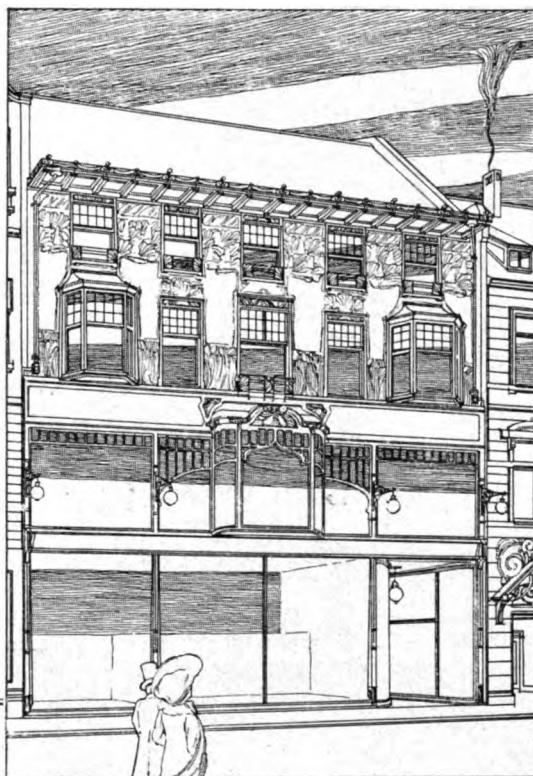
Schadowstrasse 31—33. Richard Hultsch teilweise unter Benutzung vorhandener Seitengebäude umgebaut. (Die Neubauteile sind im Grundrisse schraffiert.) (Abbild. 474). Über dem messingverkleideten Schaufenster-rahmenwerke bauen sich die Obergeschosse aus Sandstein mit Marmor- und Bronzeschmuckteilen auf. Ladeneingangsflur und Treppenhaus haben gleichfalls reichere Ausstattung in edlen Baumaterialien erfahren (Abbild. 473). Die Neu- und Umbaukosten betrugen insgesamt 180 000 M. — Das durch die Architekten Wehling & Ludwig im Jahre 1900 für den
